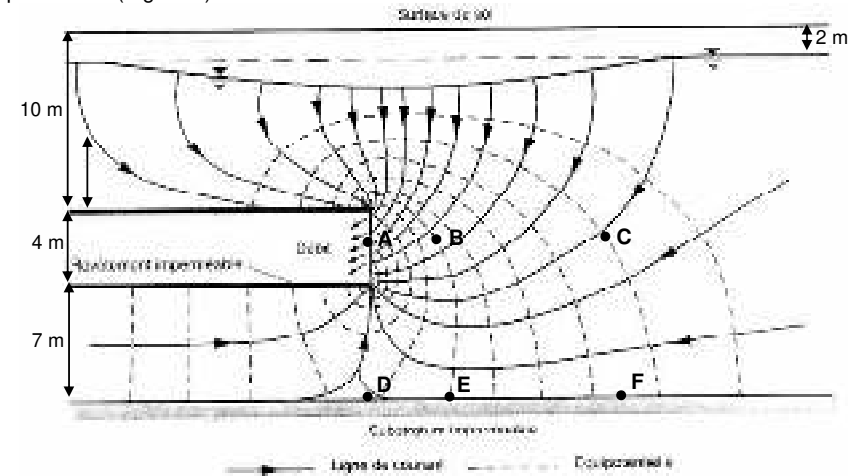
Coupe en long du tunnel, avec les conditions aux limites hydrauliques
